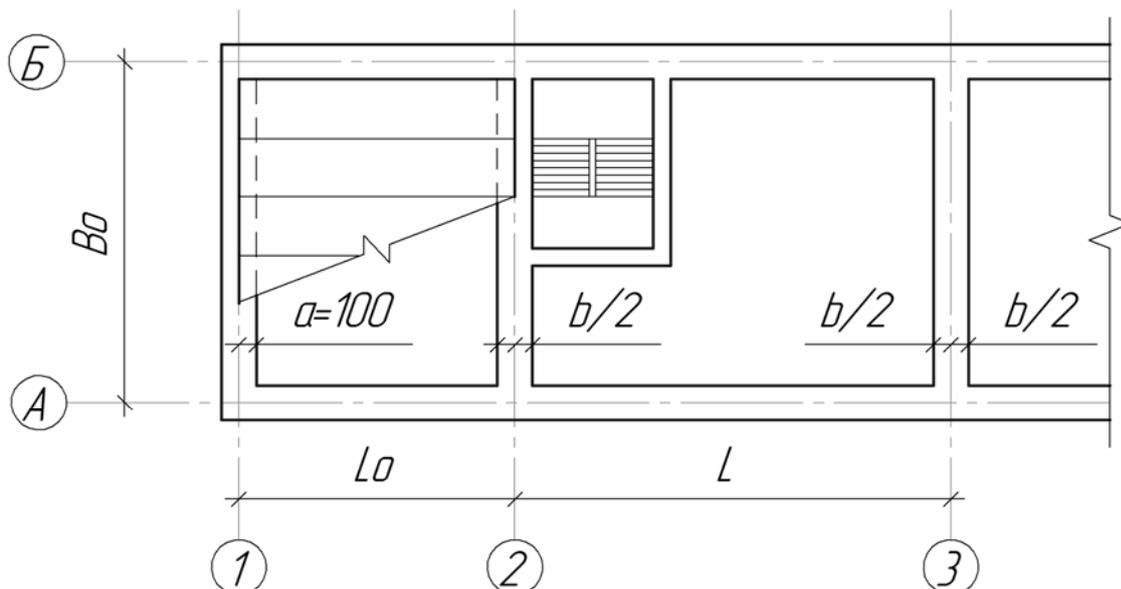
Разбивочные оси наружных и внутренних стен
